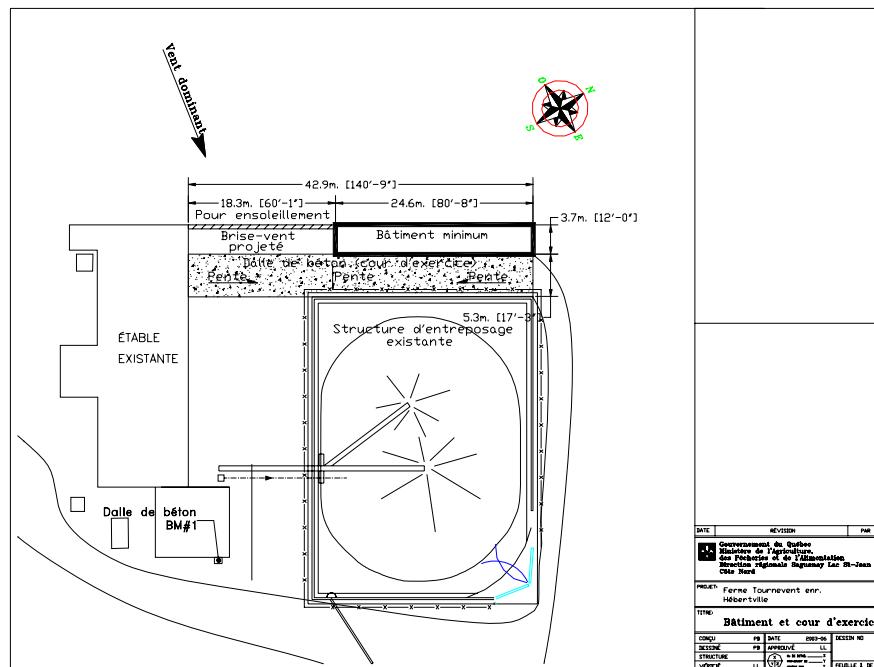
Plan d'aménagement Ferme Tournevent , Hébertville
